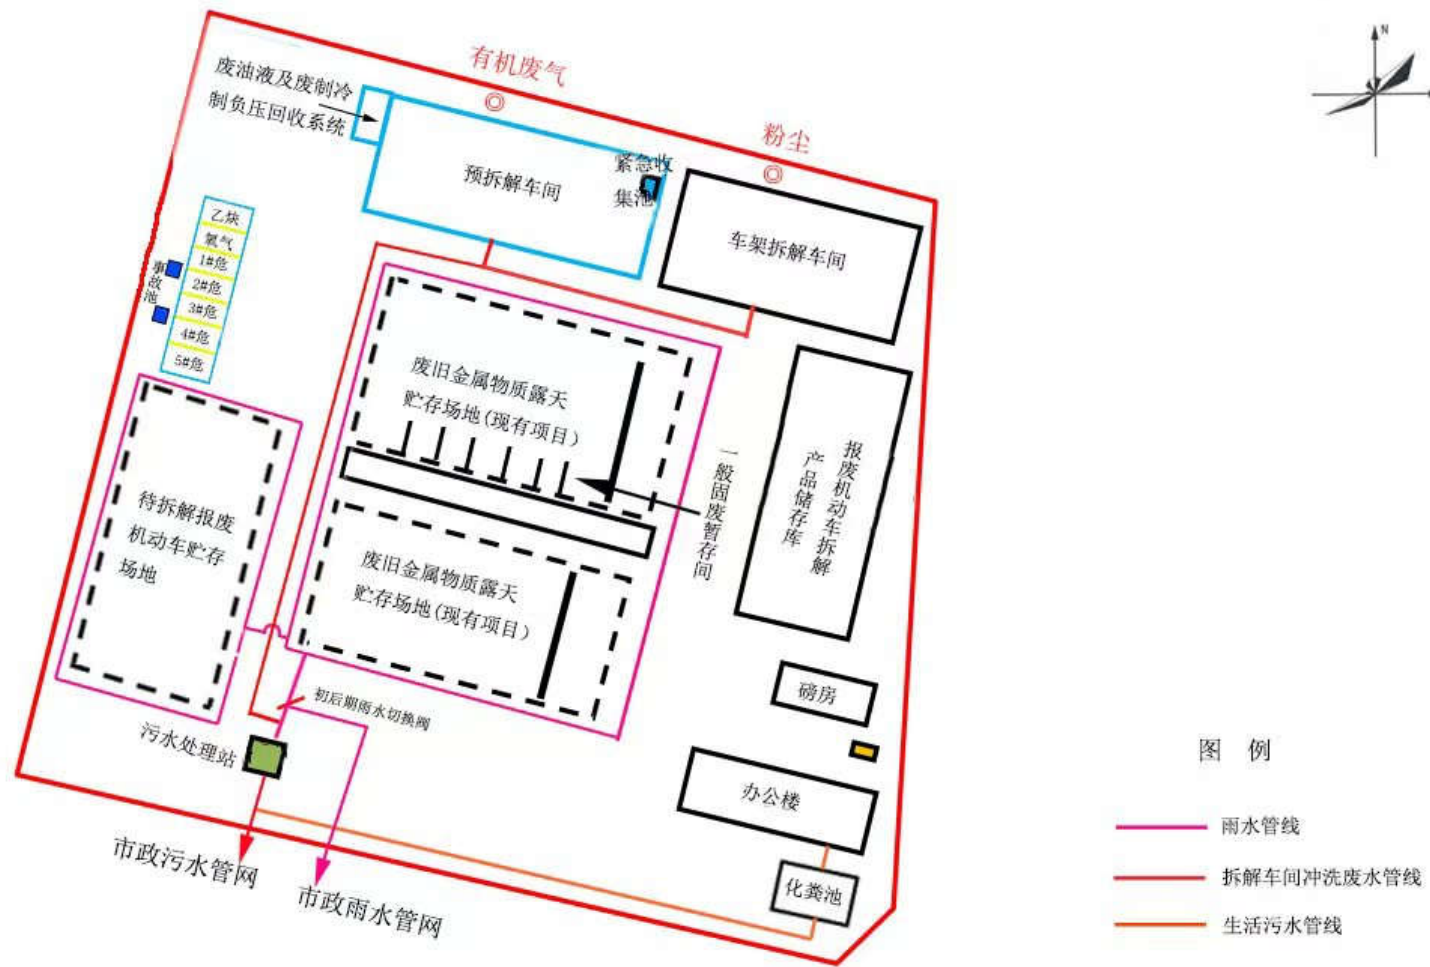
厂区平面布置及雨污水管网平面布置及流向图
